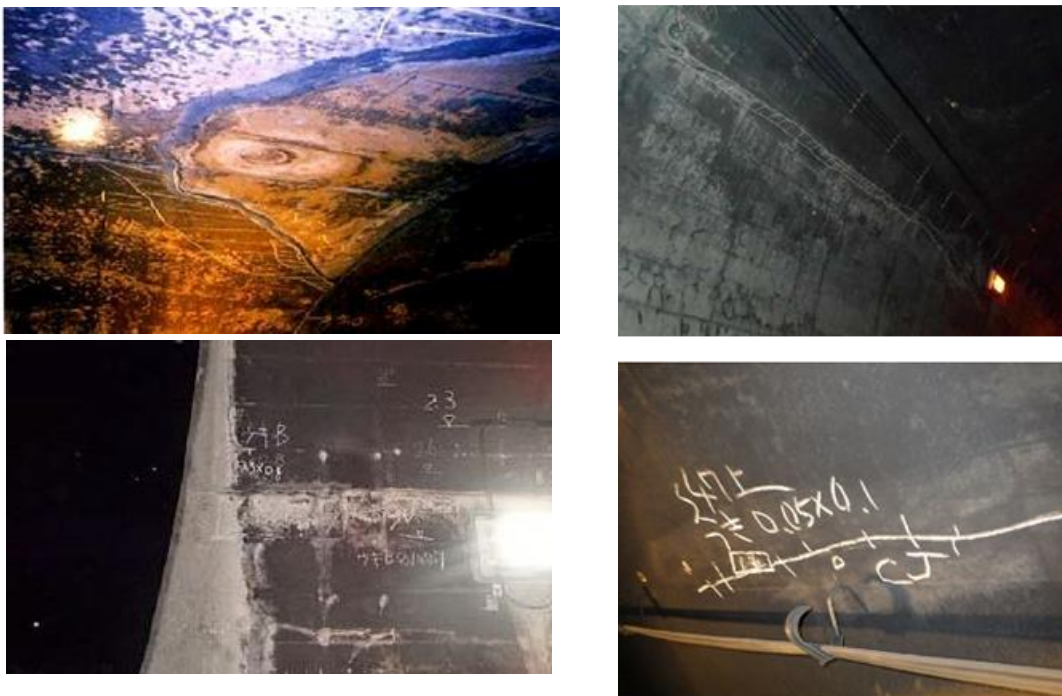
コールドジョイント付近に発生したひび割れの例 1)
